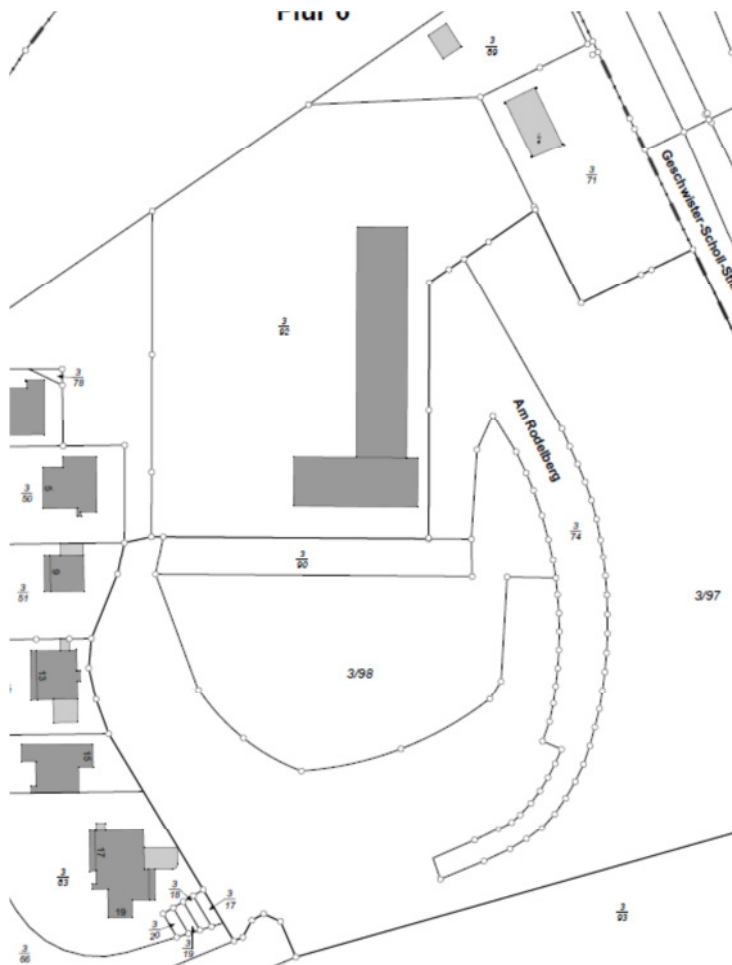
Lageplan Bestand (Vermessungsbüro Neuroth, Mainz)
